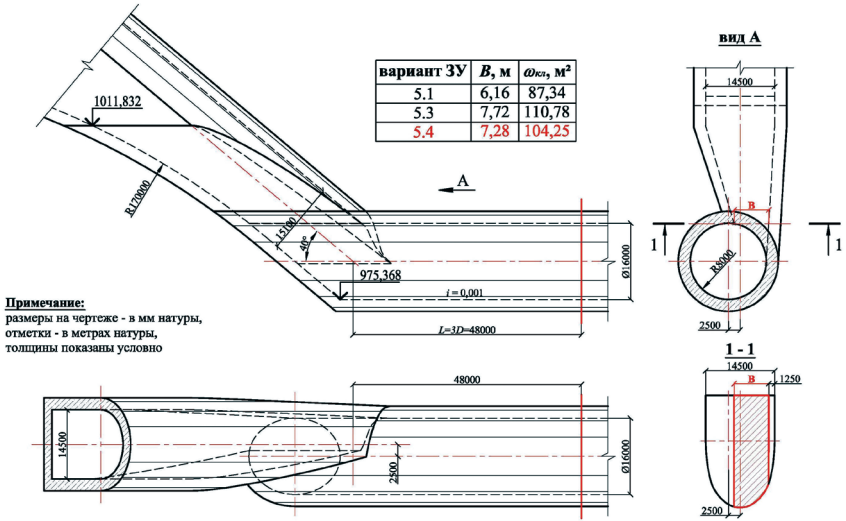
Рекомендованная конструкция закручивающего устройства (ЗУ) строительного туннеля СТ-3 по варианту 5.4
